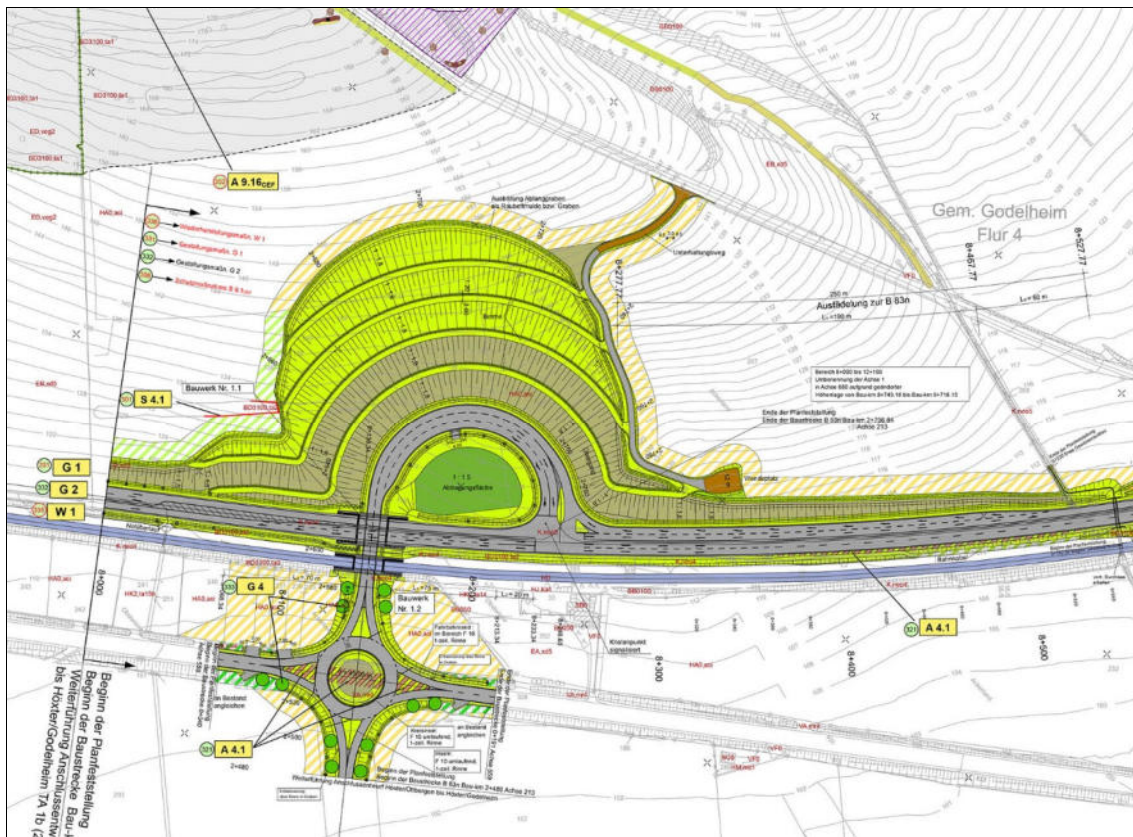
Ausschnitt aus dem Maßnahmenlageplan des LBP zu FR 10.
